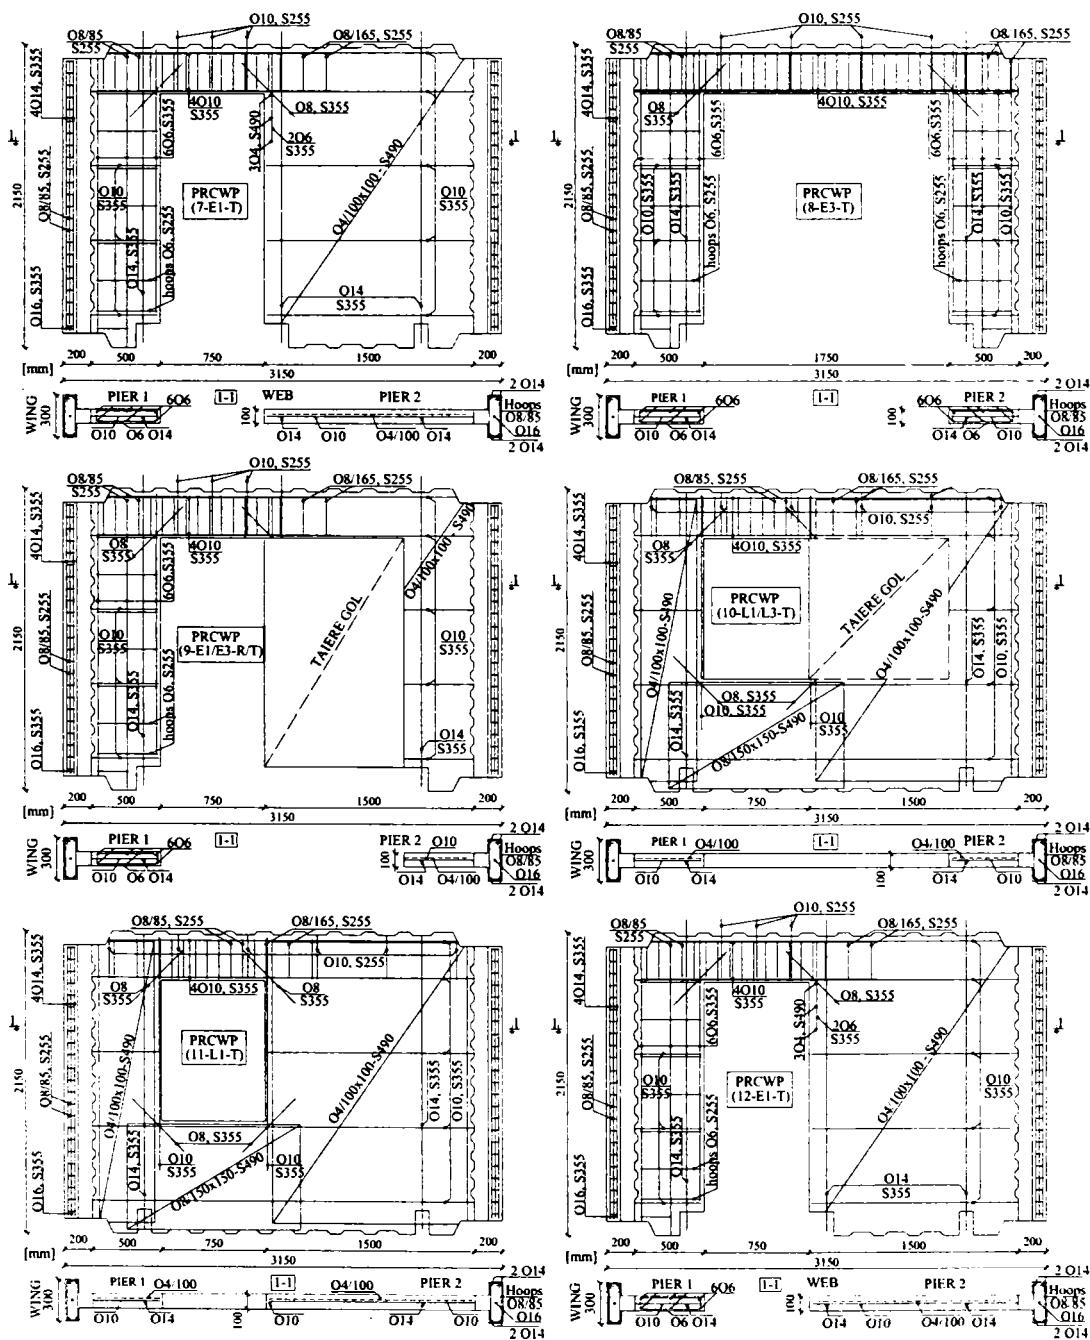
Schema și detaliile de armare ale speciimenelor
